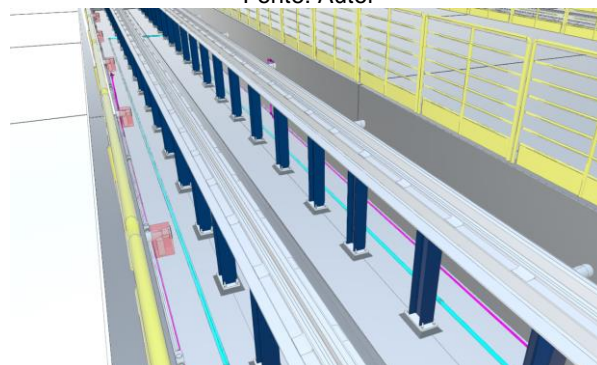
Detalhe Fixação de trilhos e estrutura P2
